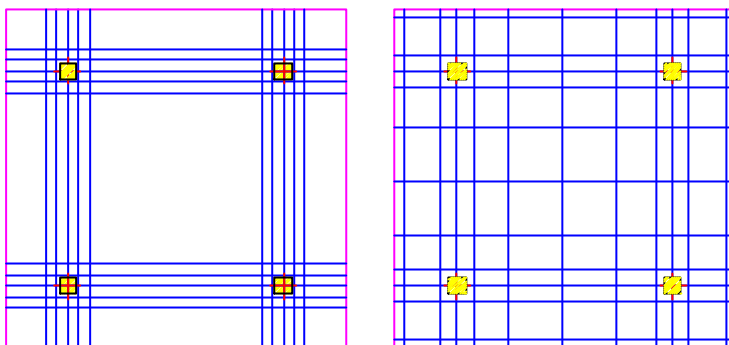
Lajes Nervuradas Bidirecionais + Vigas ou Capitéis
